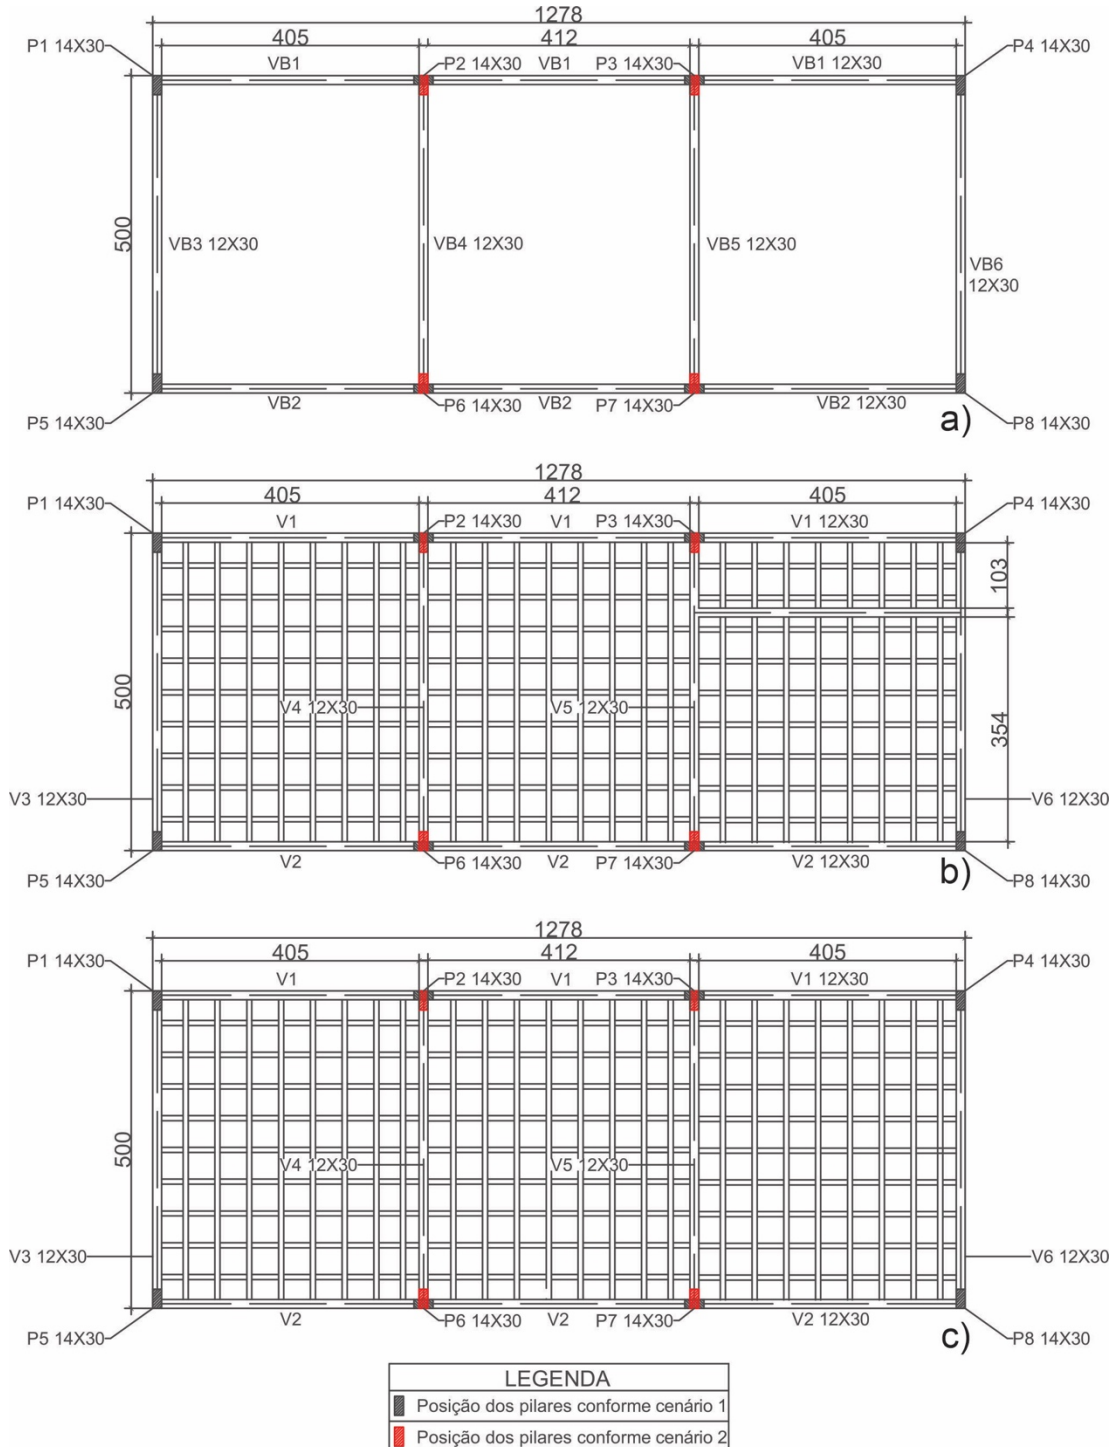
Direção dos pilares adotada nos diferentes cenários simulados para o nível das: a) vigas baldramas (térreo); b) vigas do primeiro pavimento; c) vigas da cobertura (pavimento superior).
